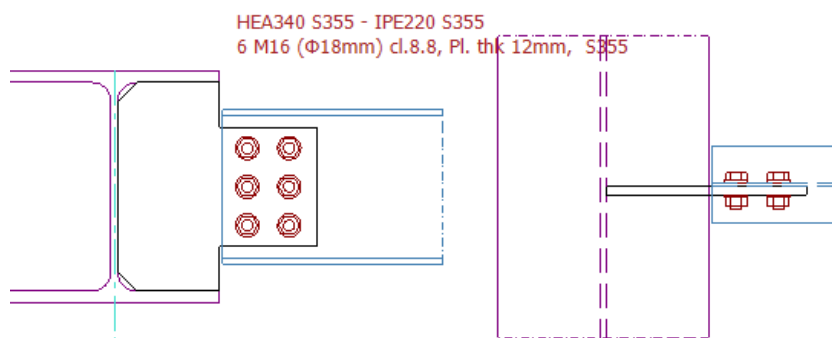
Ligação aparafusada do perfil HEA 340 ao perfil IPE 220
